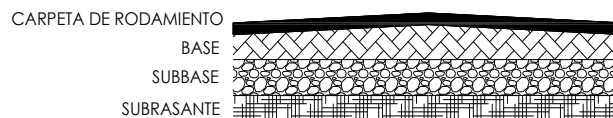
ESTRUCTURA DE UN PAVIMENTO FLEXIBLE.
